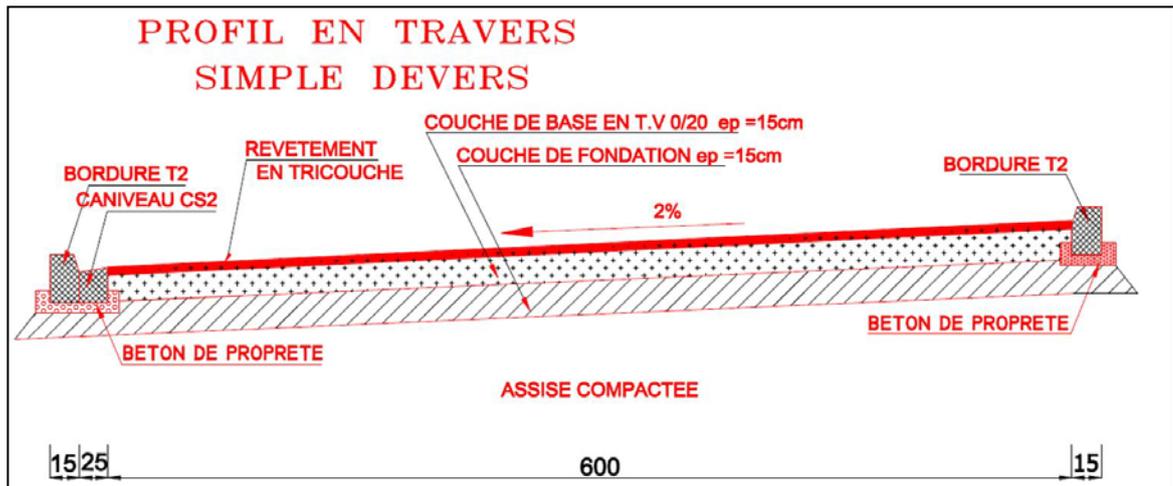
Coupe type du corps de chaussée type voie en enrobé avec simple dévers
